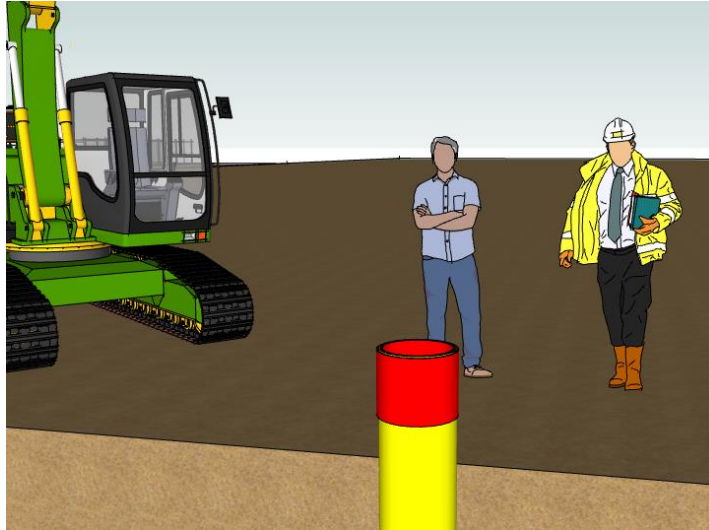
Geotextil colocado dentro de la camisa metálica recuperable.
